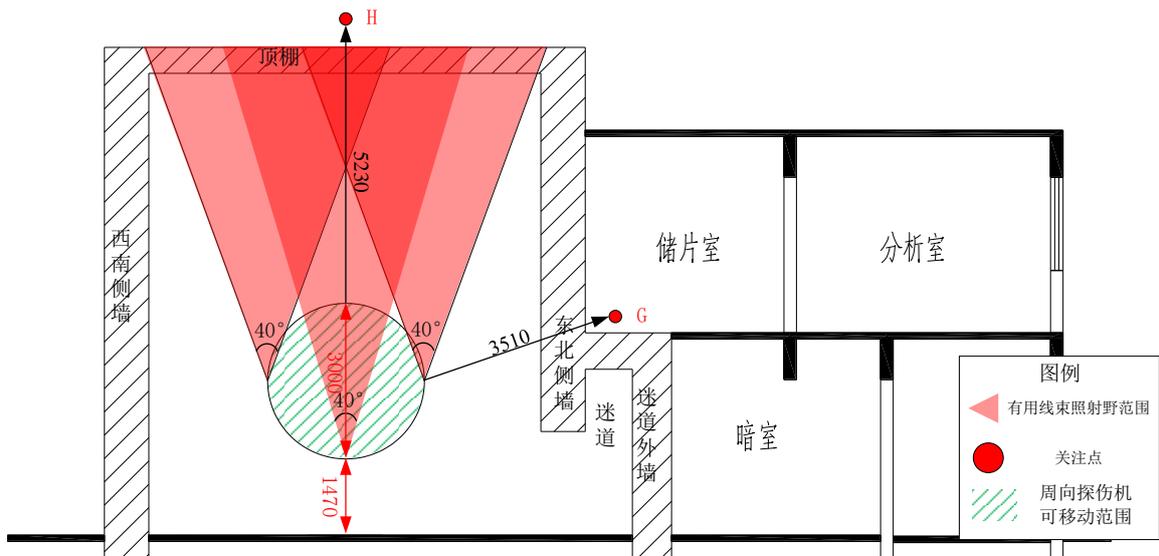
探伤室周向探伤机关注点位示意图（剖面图 1）
